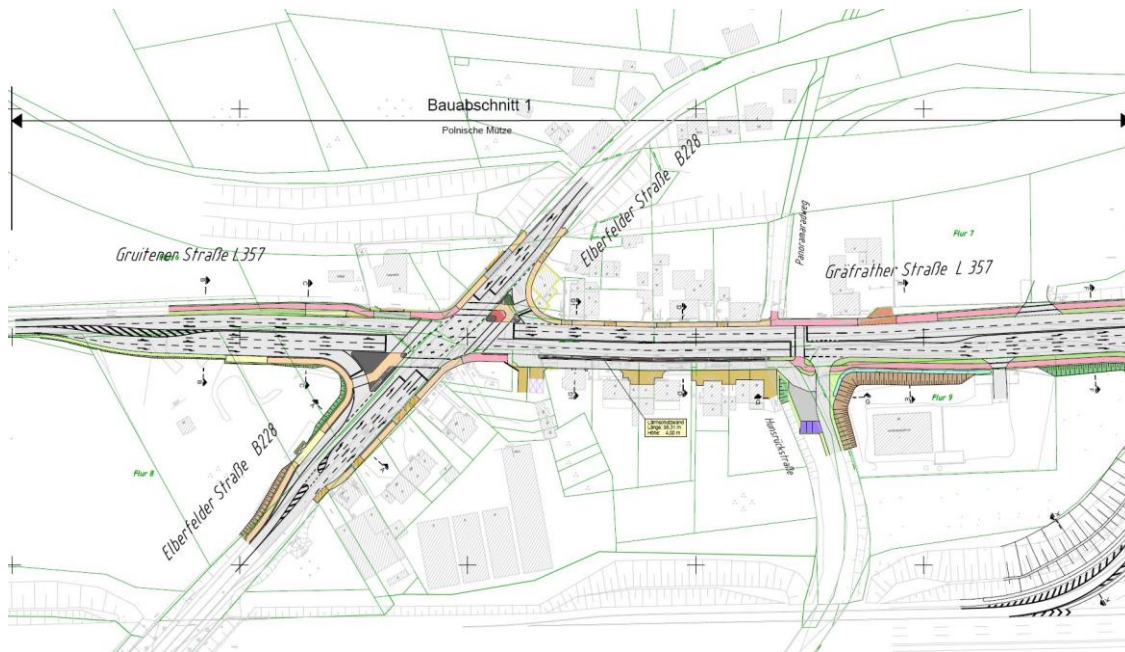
Knoten „Polnische Mütze“ – geplanter Ausbau¹⁴
